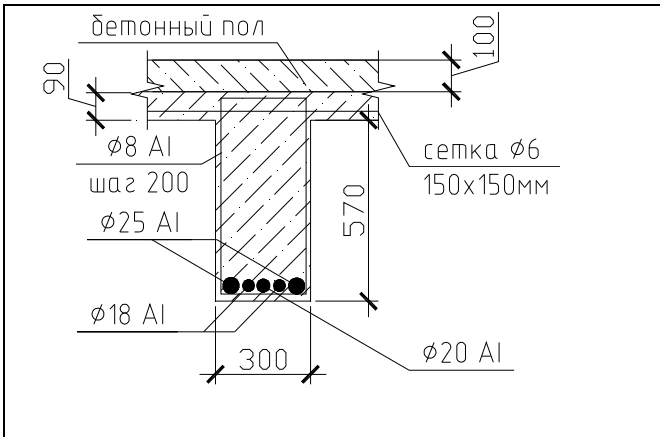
Главная балка ж/б перекрытия над первым этажом
